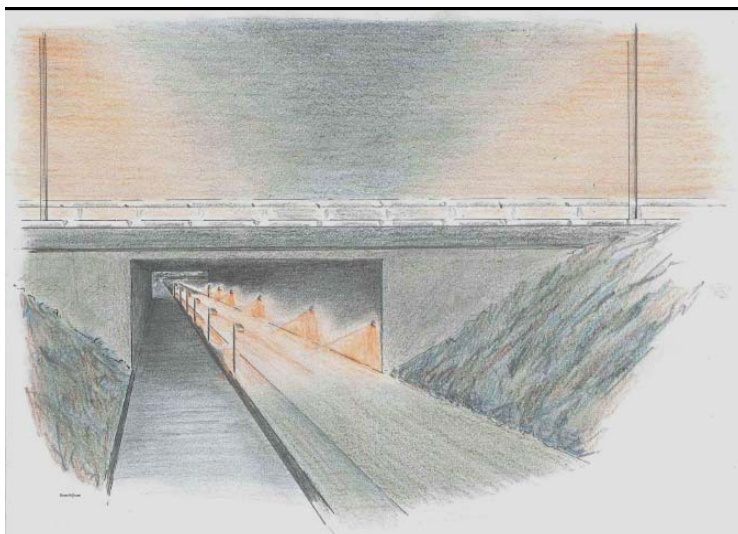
Vermindering van verstrooiing van licht door lager aanbrengen van verlichting
